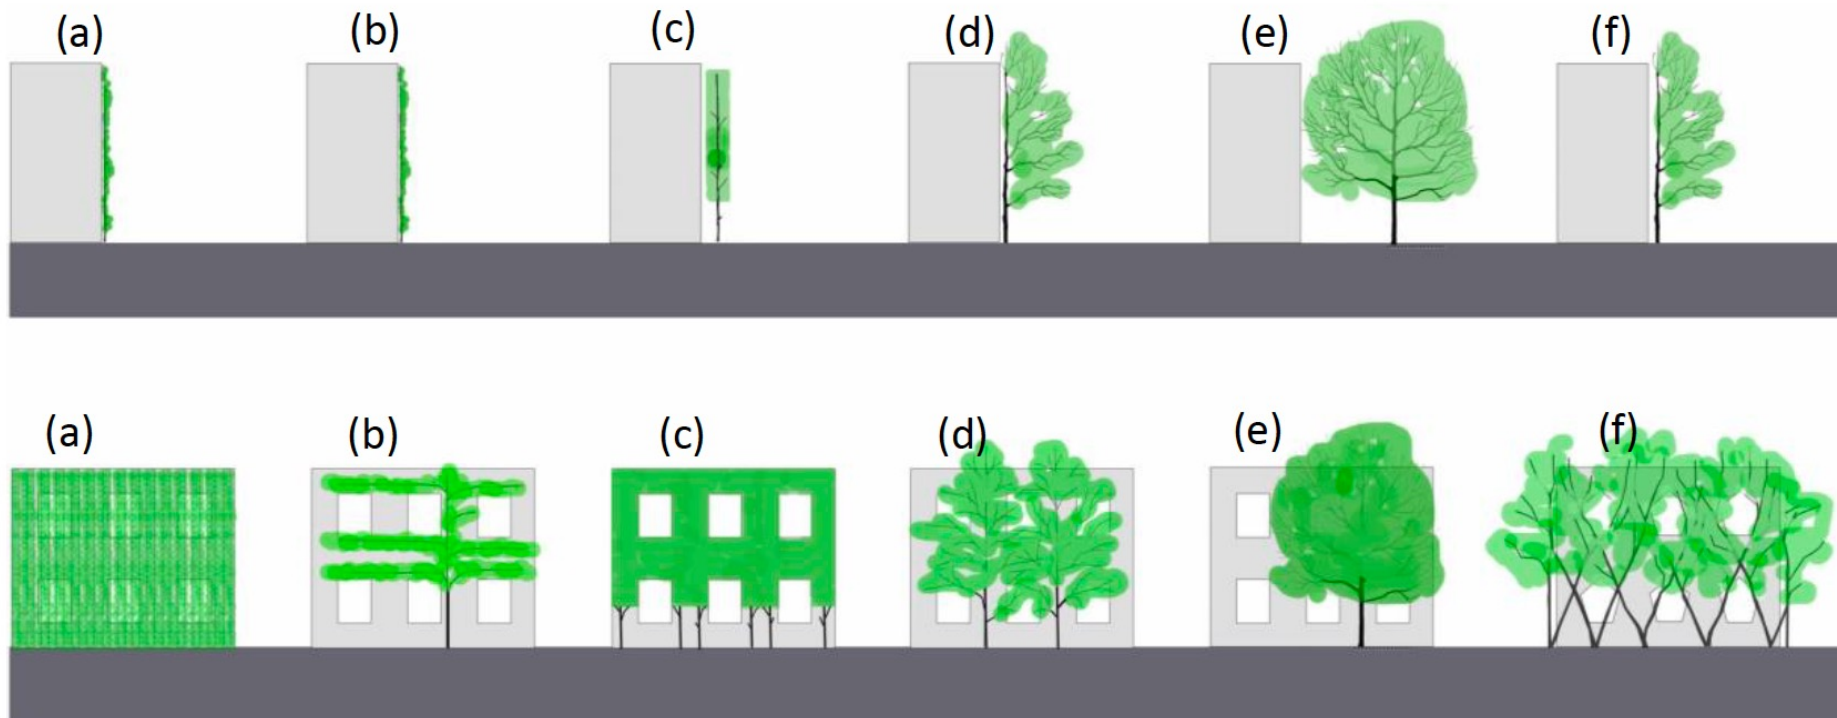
(a) bodengebundene Fassadenbegrünung, (b) Spalierbaum, (c) Hochstammhecke, (d) Baumfassade, (e) Haus vorm Baum, (f) Baubotanik Fassade in Schnitt (oben) und Ansicht (unten) (Lisa Höpfl)
